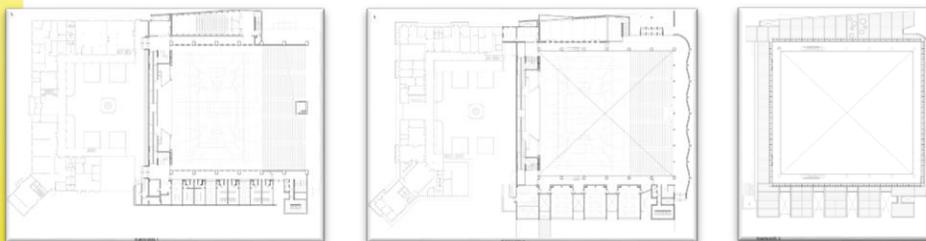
, 41 y 42: Plantas Arquitectónicas, “Centro de Encuentro Chimkowe.”
